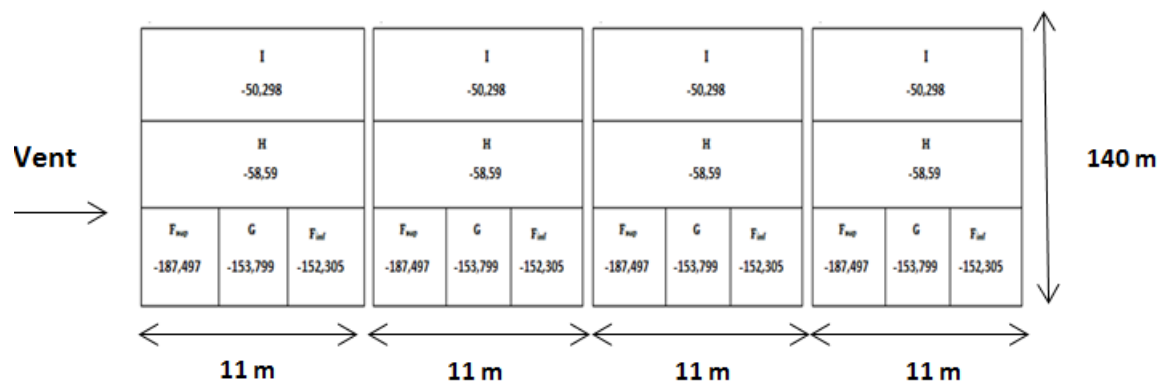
Pressions sur la toiture directions du vent (V1,V3) [daN/m²].
